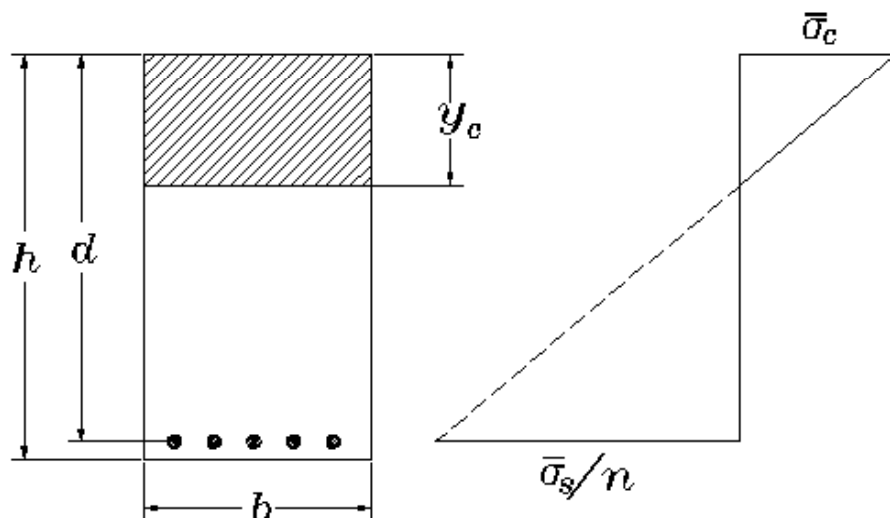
Sezione rettangolare con semplice armatura: condizioni di progetto.
